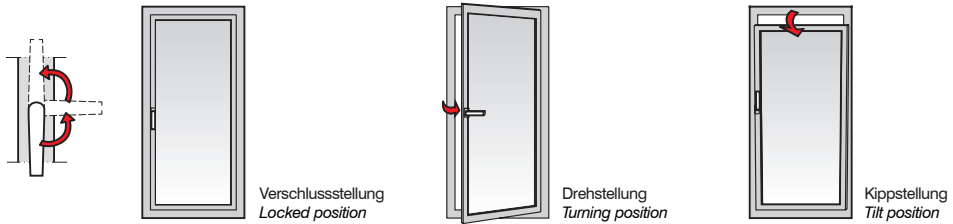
Einstellungen bei abschließbaren Fenstertüren
